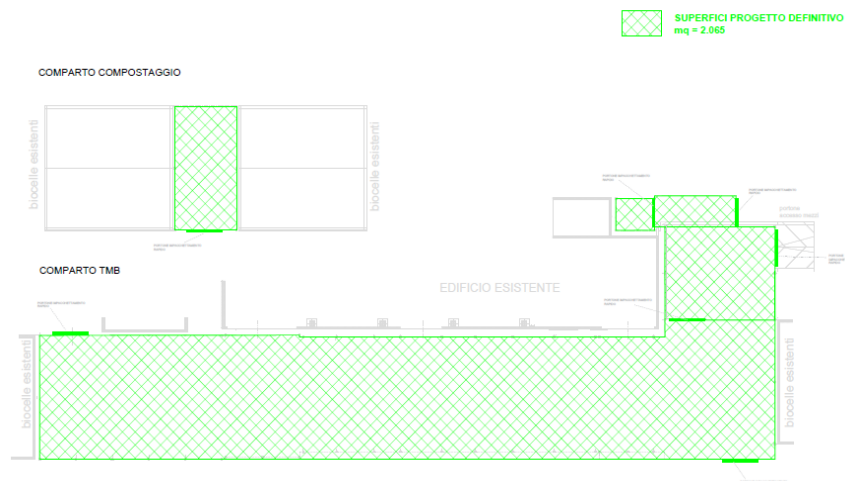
stralcio estratto da Tav.9 bis rev.00 "Lay out nuove coperture" – Progetto approvato con DD 151/2002
